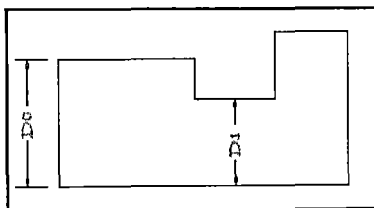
lado mayor para las plantas tipo L, T, U
